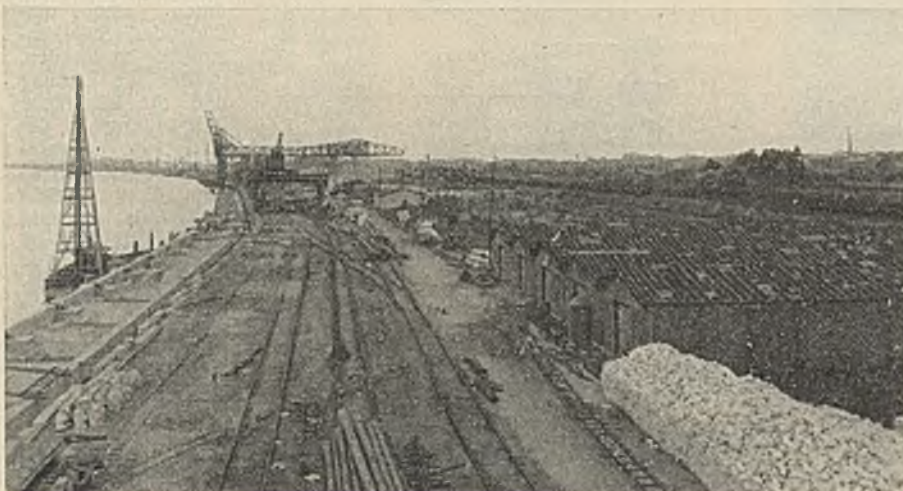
Blick auf die Baustelle mit einem Teil der fertigbetonierten Mauer.
